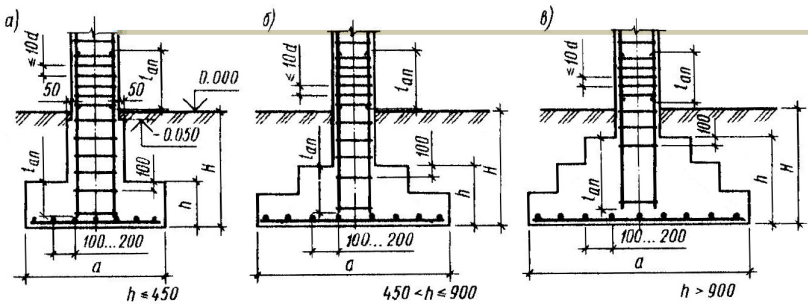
Поперечный профиль и армирование монолитных отдельных фундаментов под колонны: *а* – одноступенчатый фундамент с подколонником; *б, в* – двух- и трехступенчатые фундаменты
